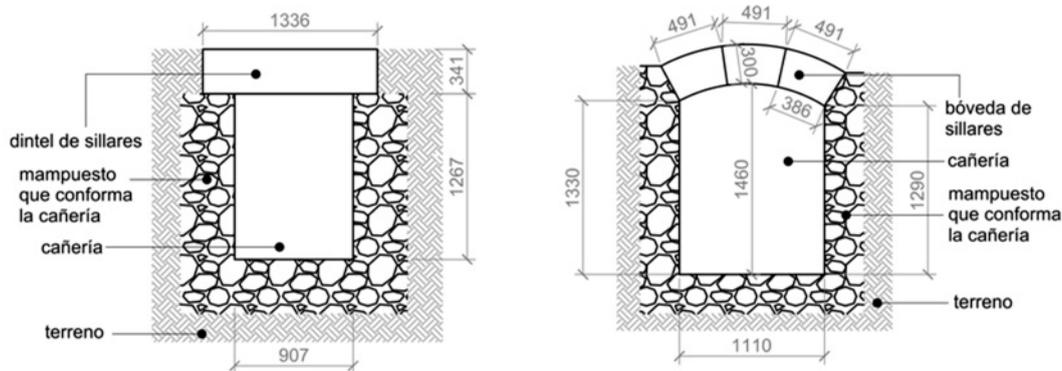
Secciones de las cañerías del interior de la Villa. A la izquierda propuesta de cañería para la zona de extramuros redibujado de un plano del S.XVII. A la derecha levantamiento realizado por el autor a los restos de una de las cañerías que se conserva en la calle de Teniente Rey, nótese la similitud de las dimensiones y se deduce que el dintel de la derecha por lo general debió construirse como la bóveda de la derecha.
